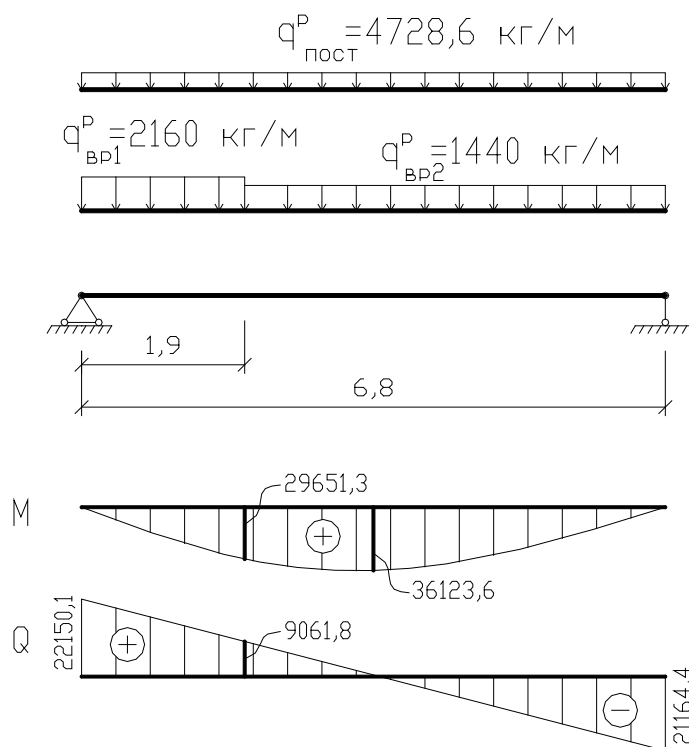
Розрахункова схема та епюри зусиль, що діють в перерізах ригеля
